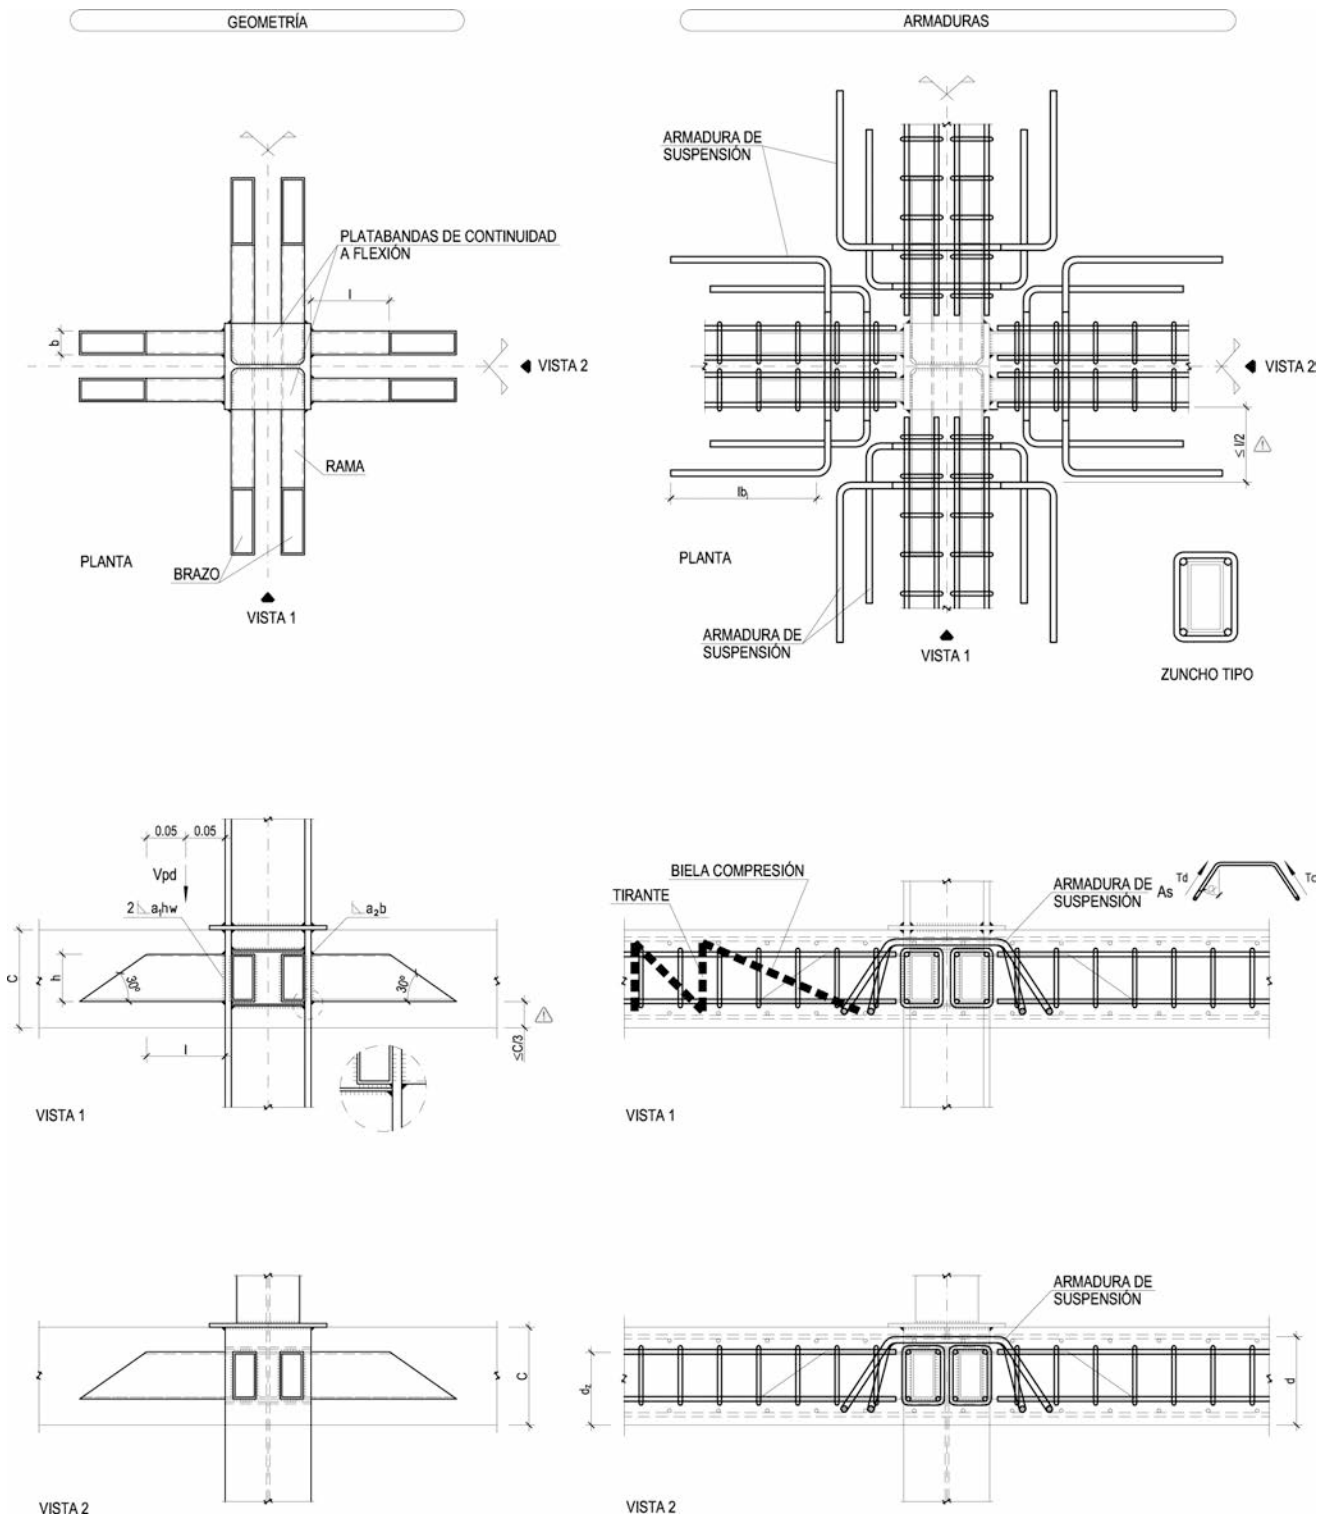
Detalle de punzonamiento entre soportes metálicos y forjados de hormigón con crucetas metálicas recortadas
